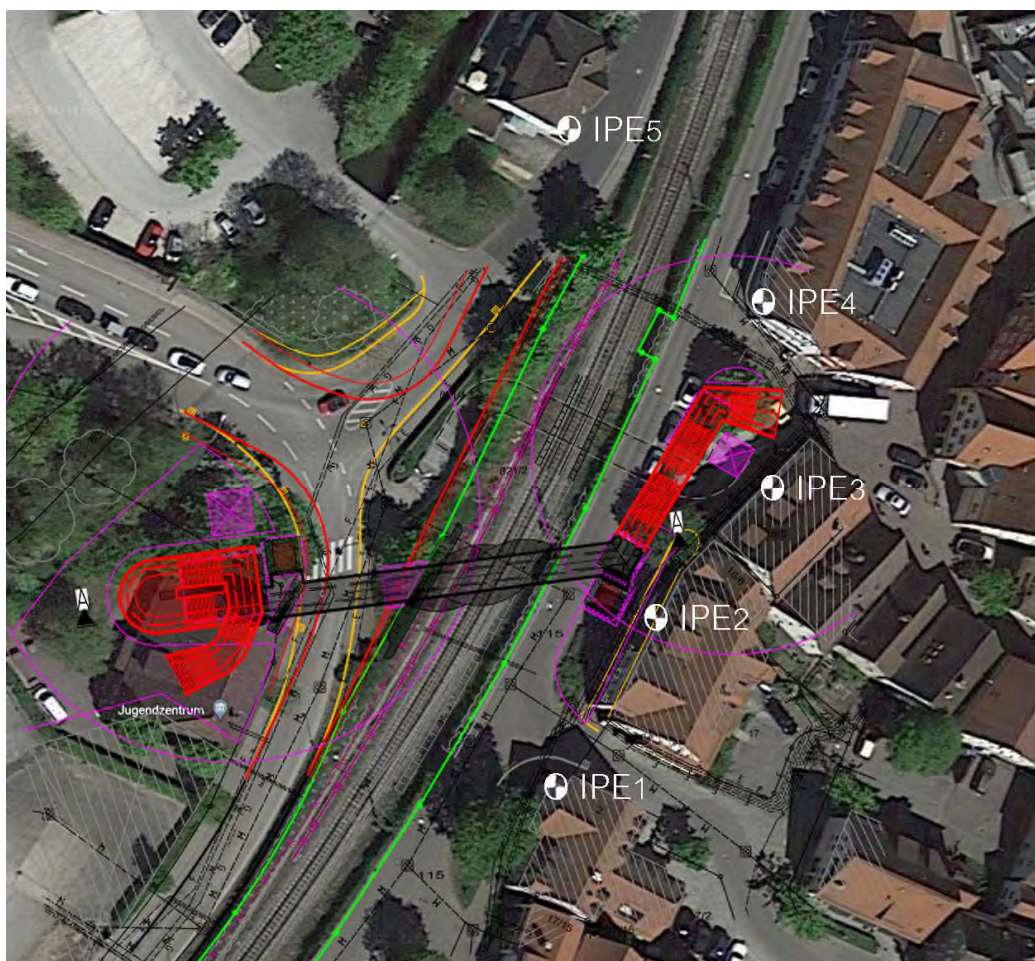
Lage der Immissionsorte inkl. Darstellung der geplanten Fußgängerüberführung
